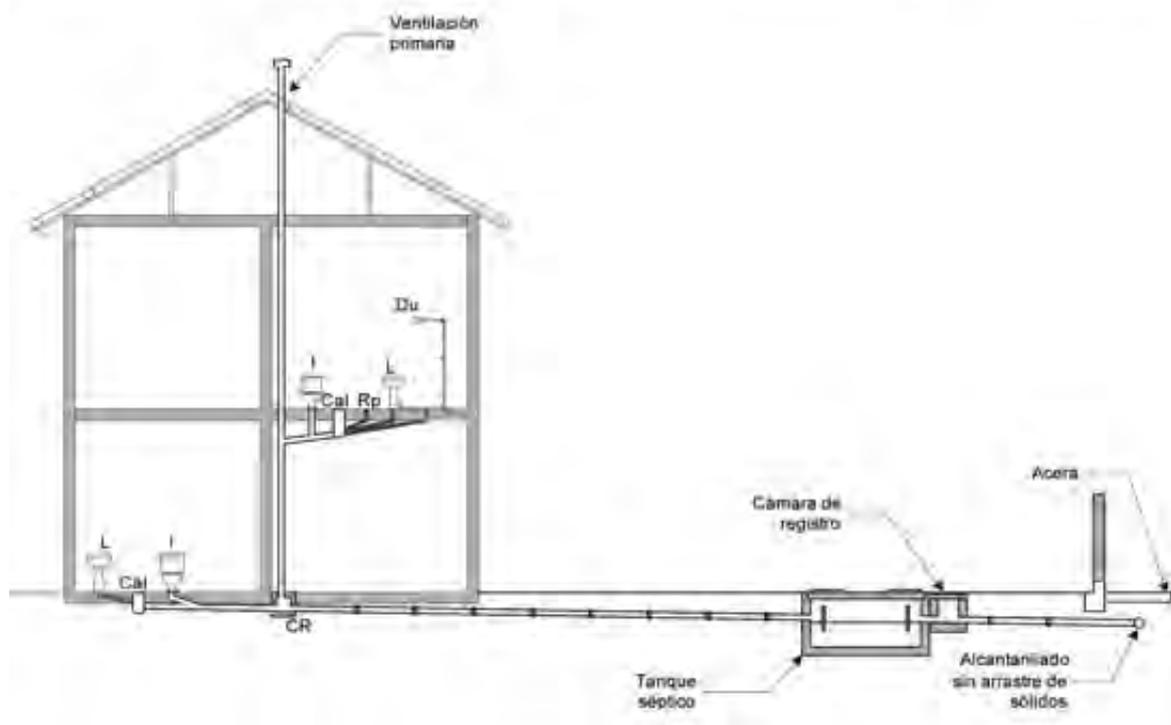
Sistema de alcantarillado sanitario sin arrastre de sólidos
